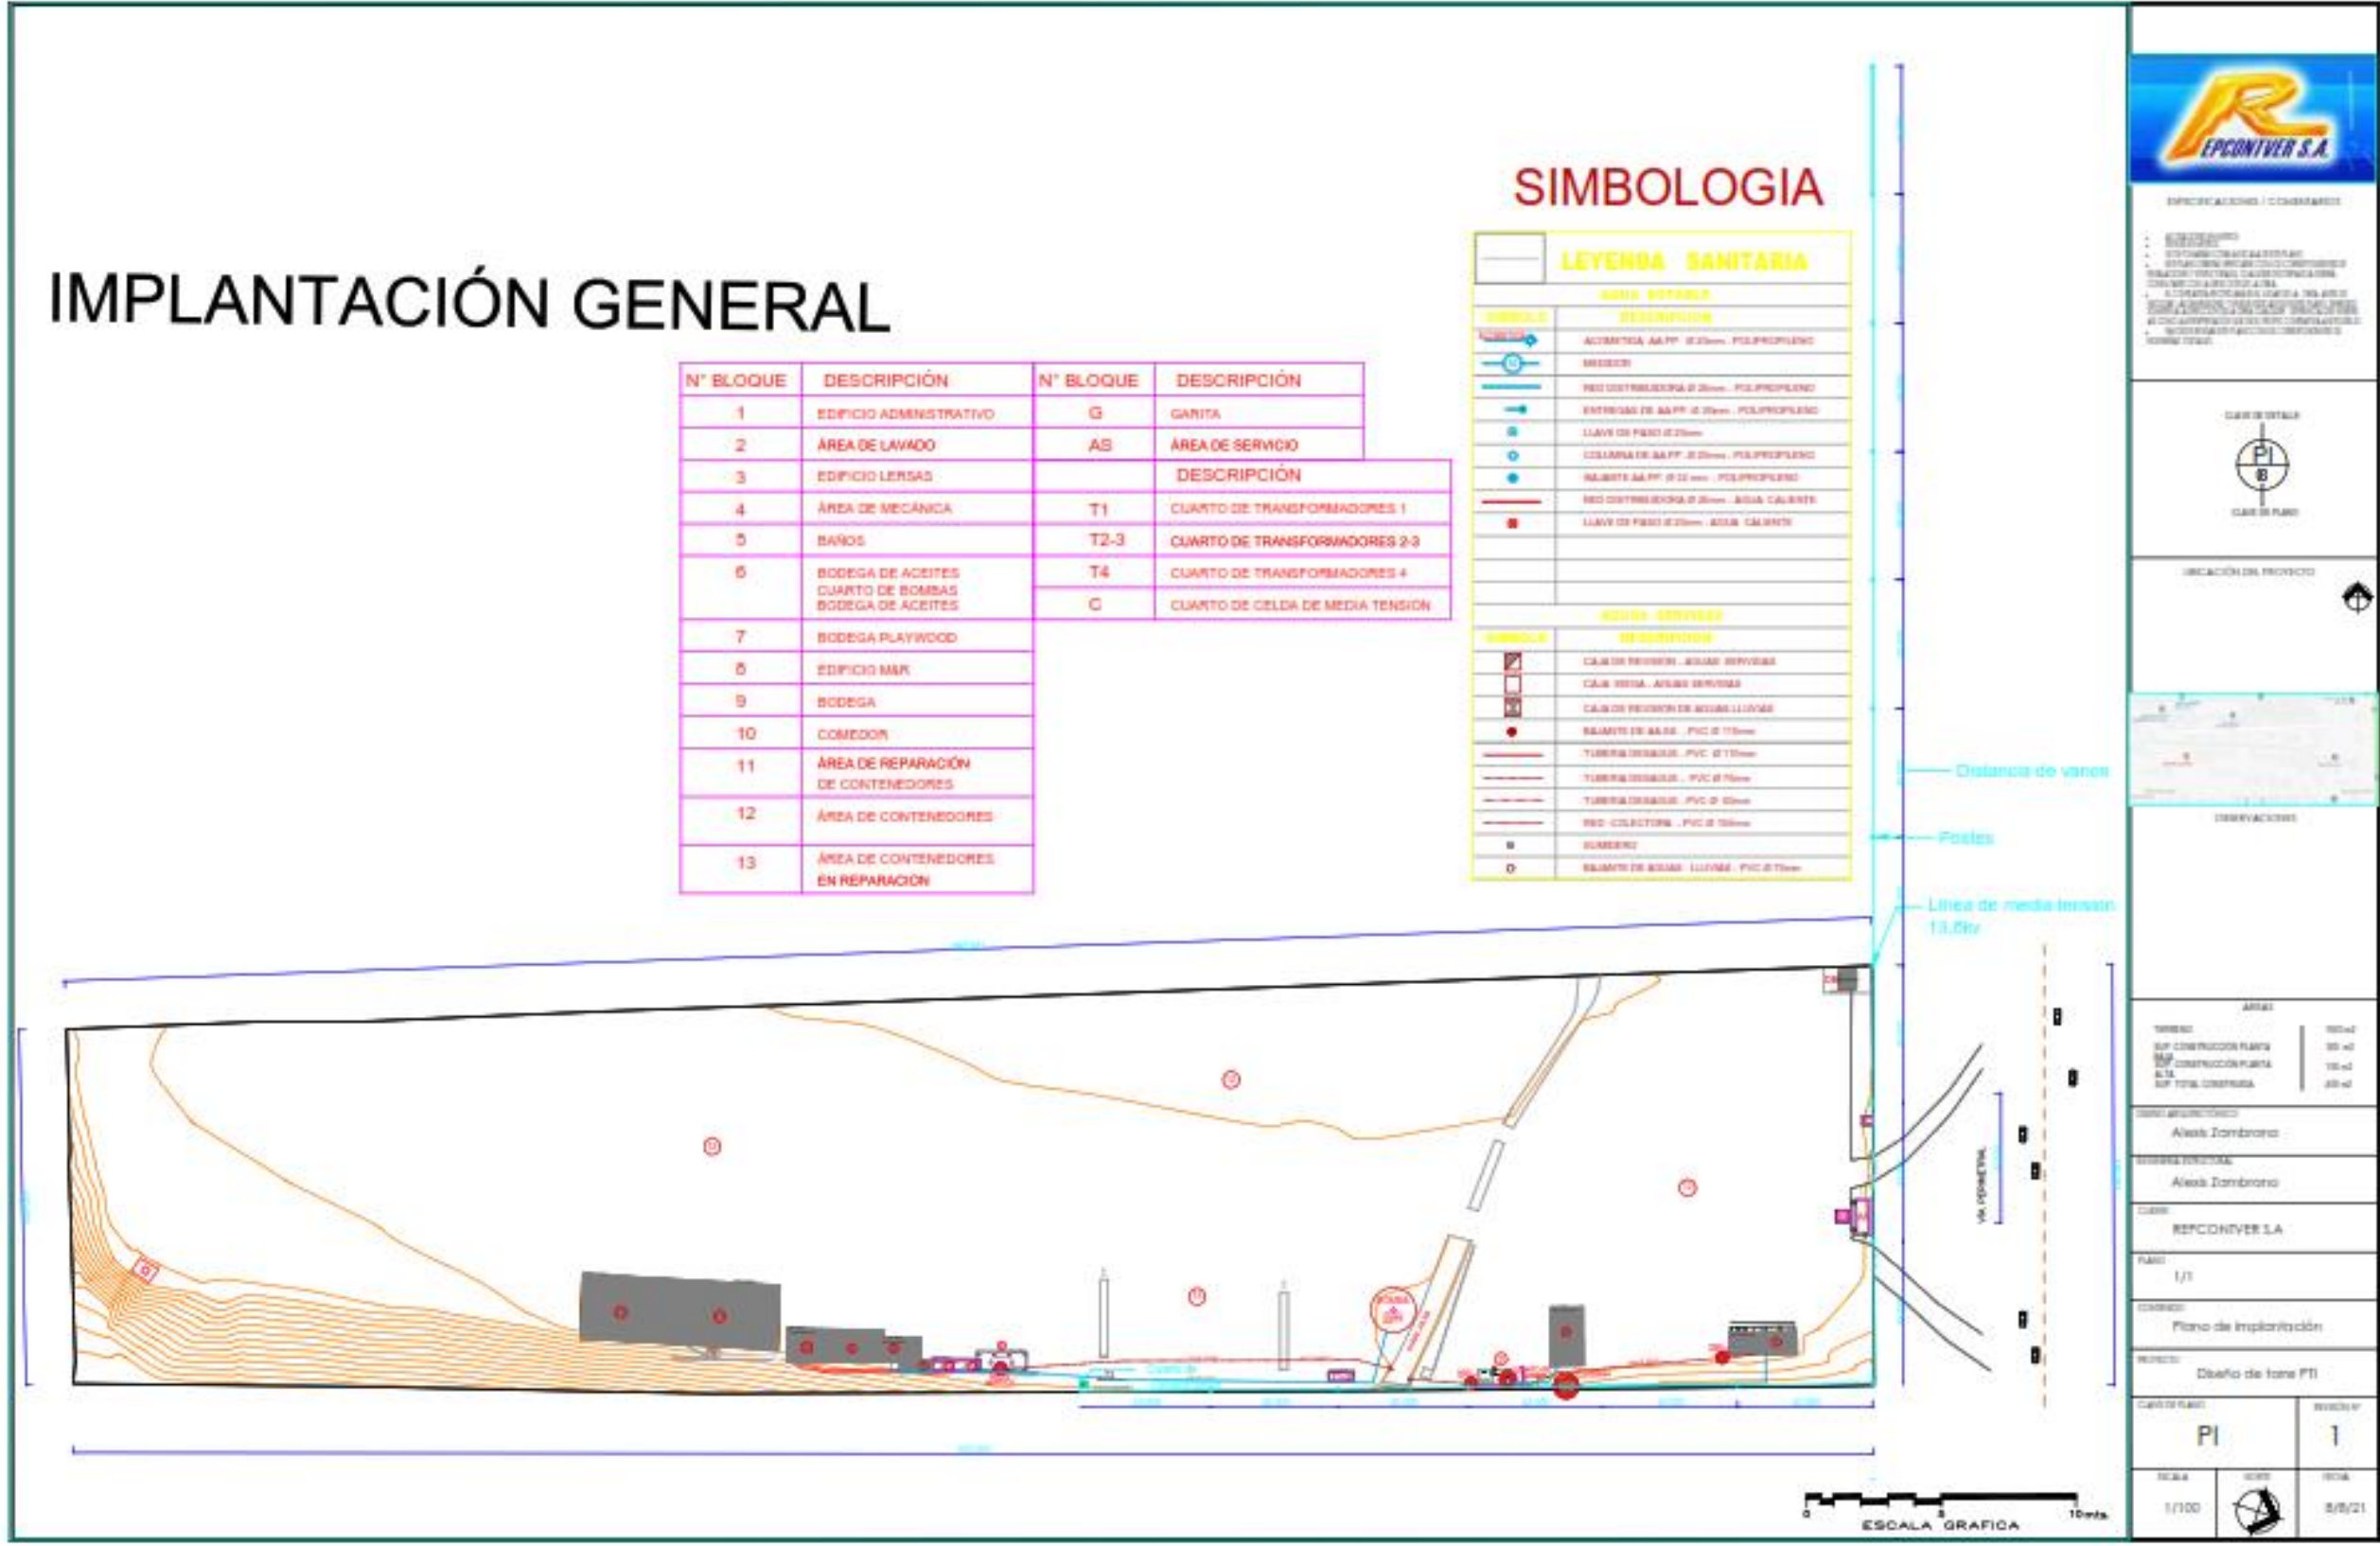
Plano de implantación de la empresa REPCONTVER S.A
